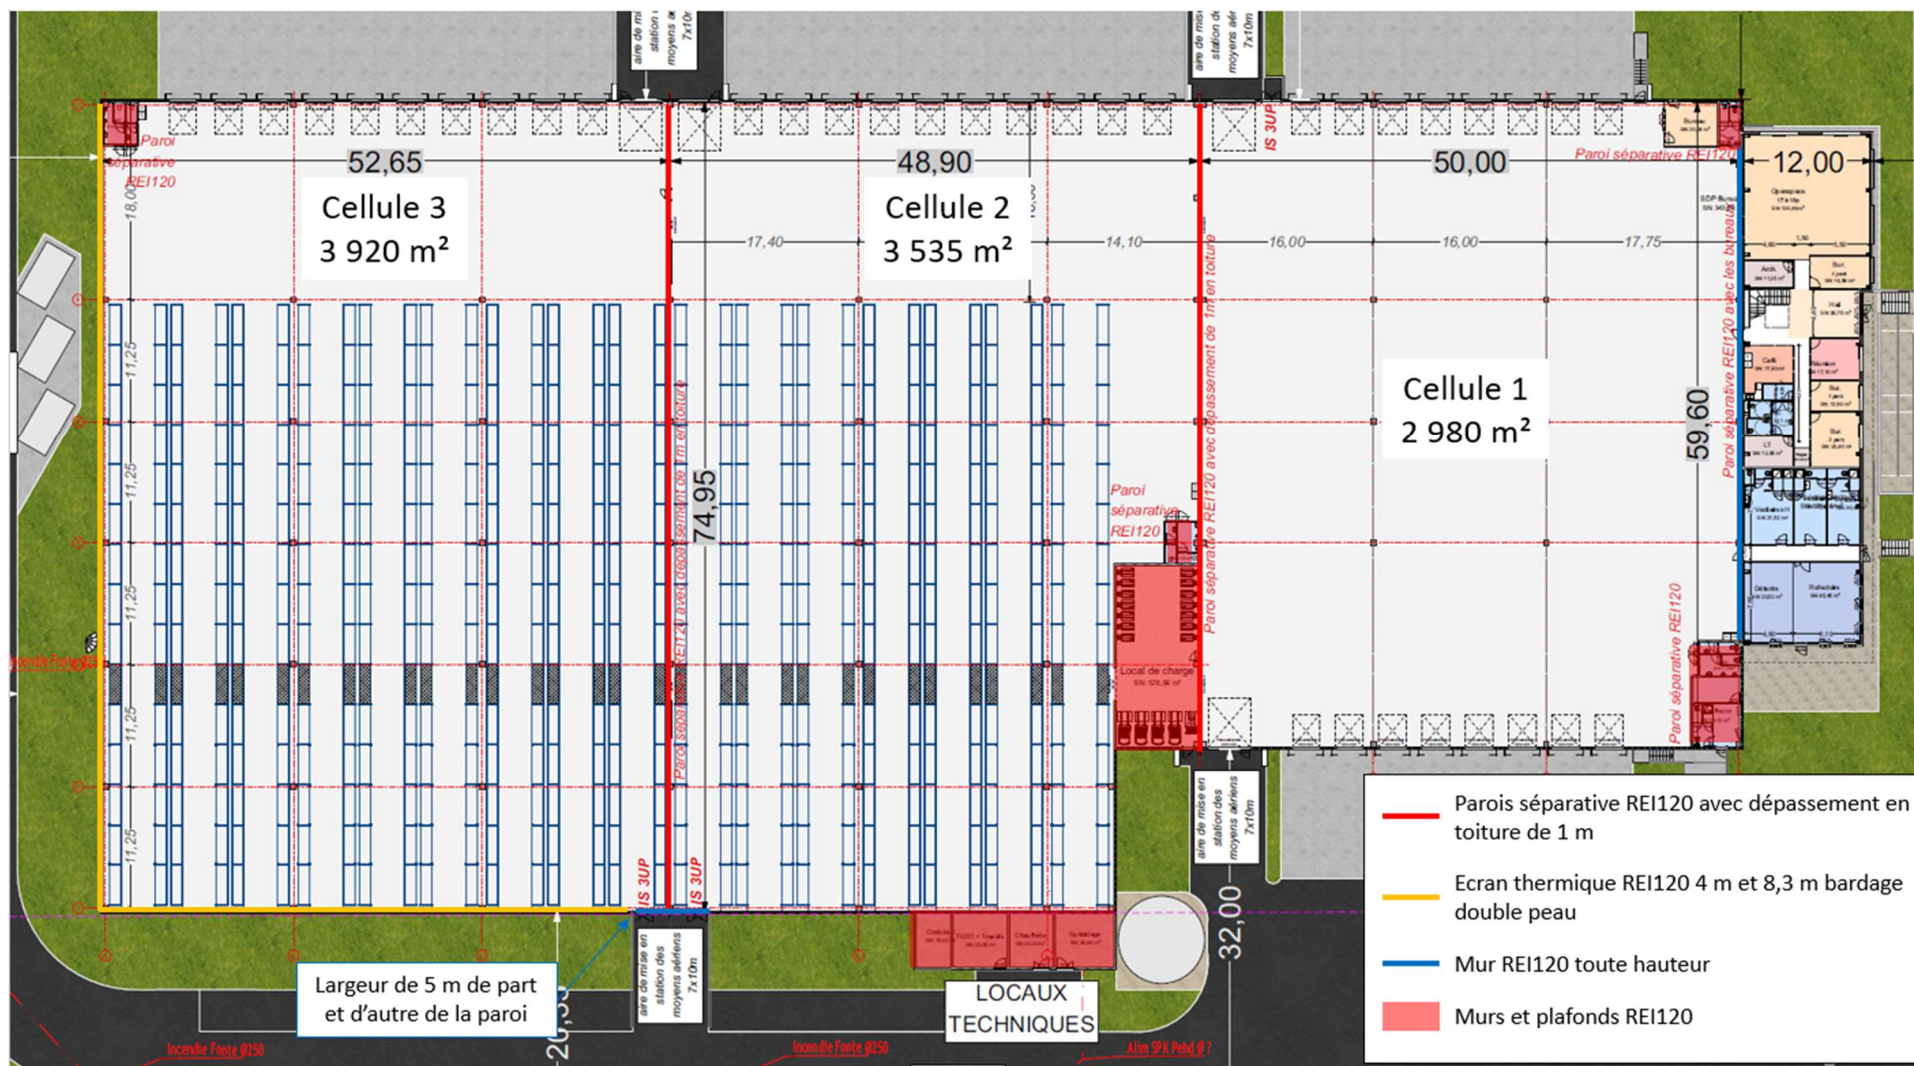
Plan des murs coupe-feu de l'entrepôt
